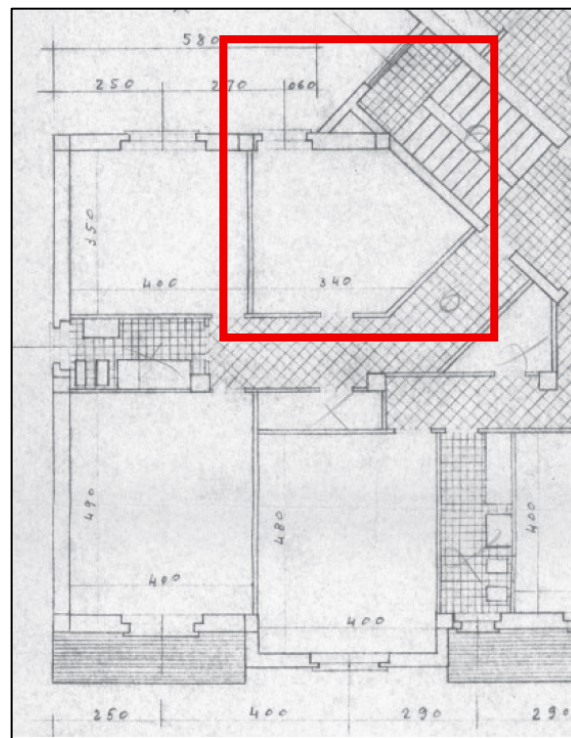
Piano 1°-2°-3° approvato 1.04.1965
